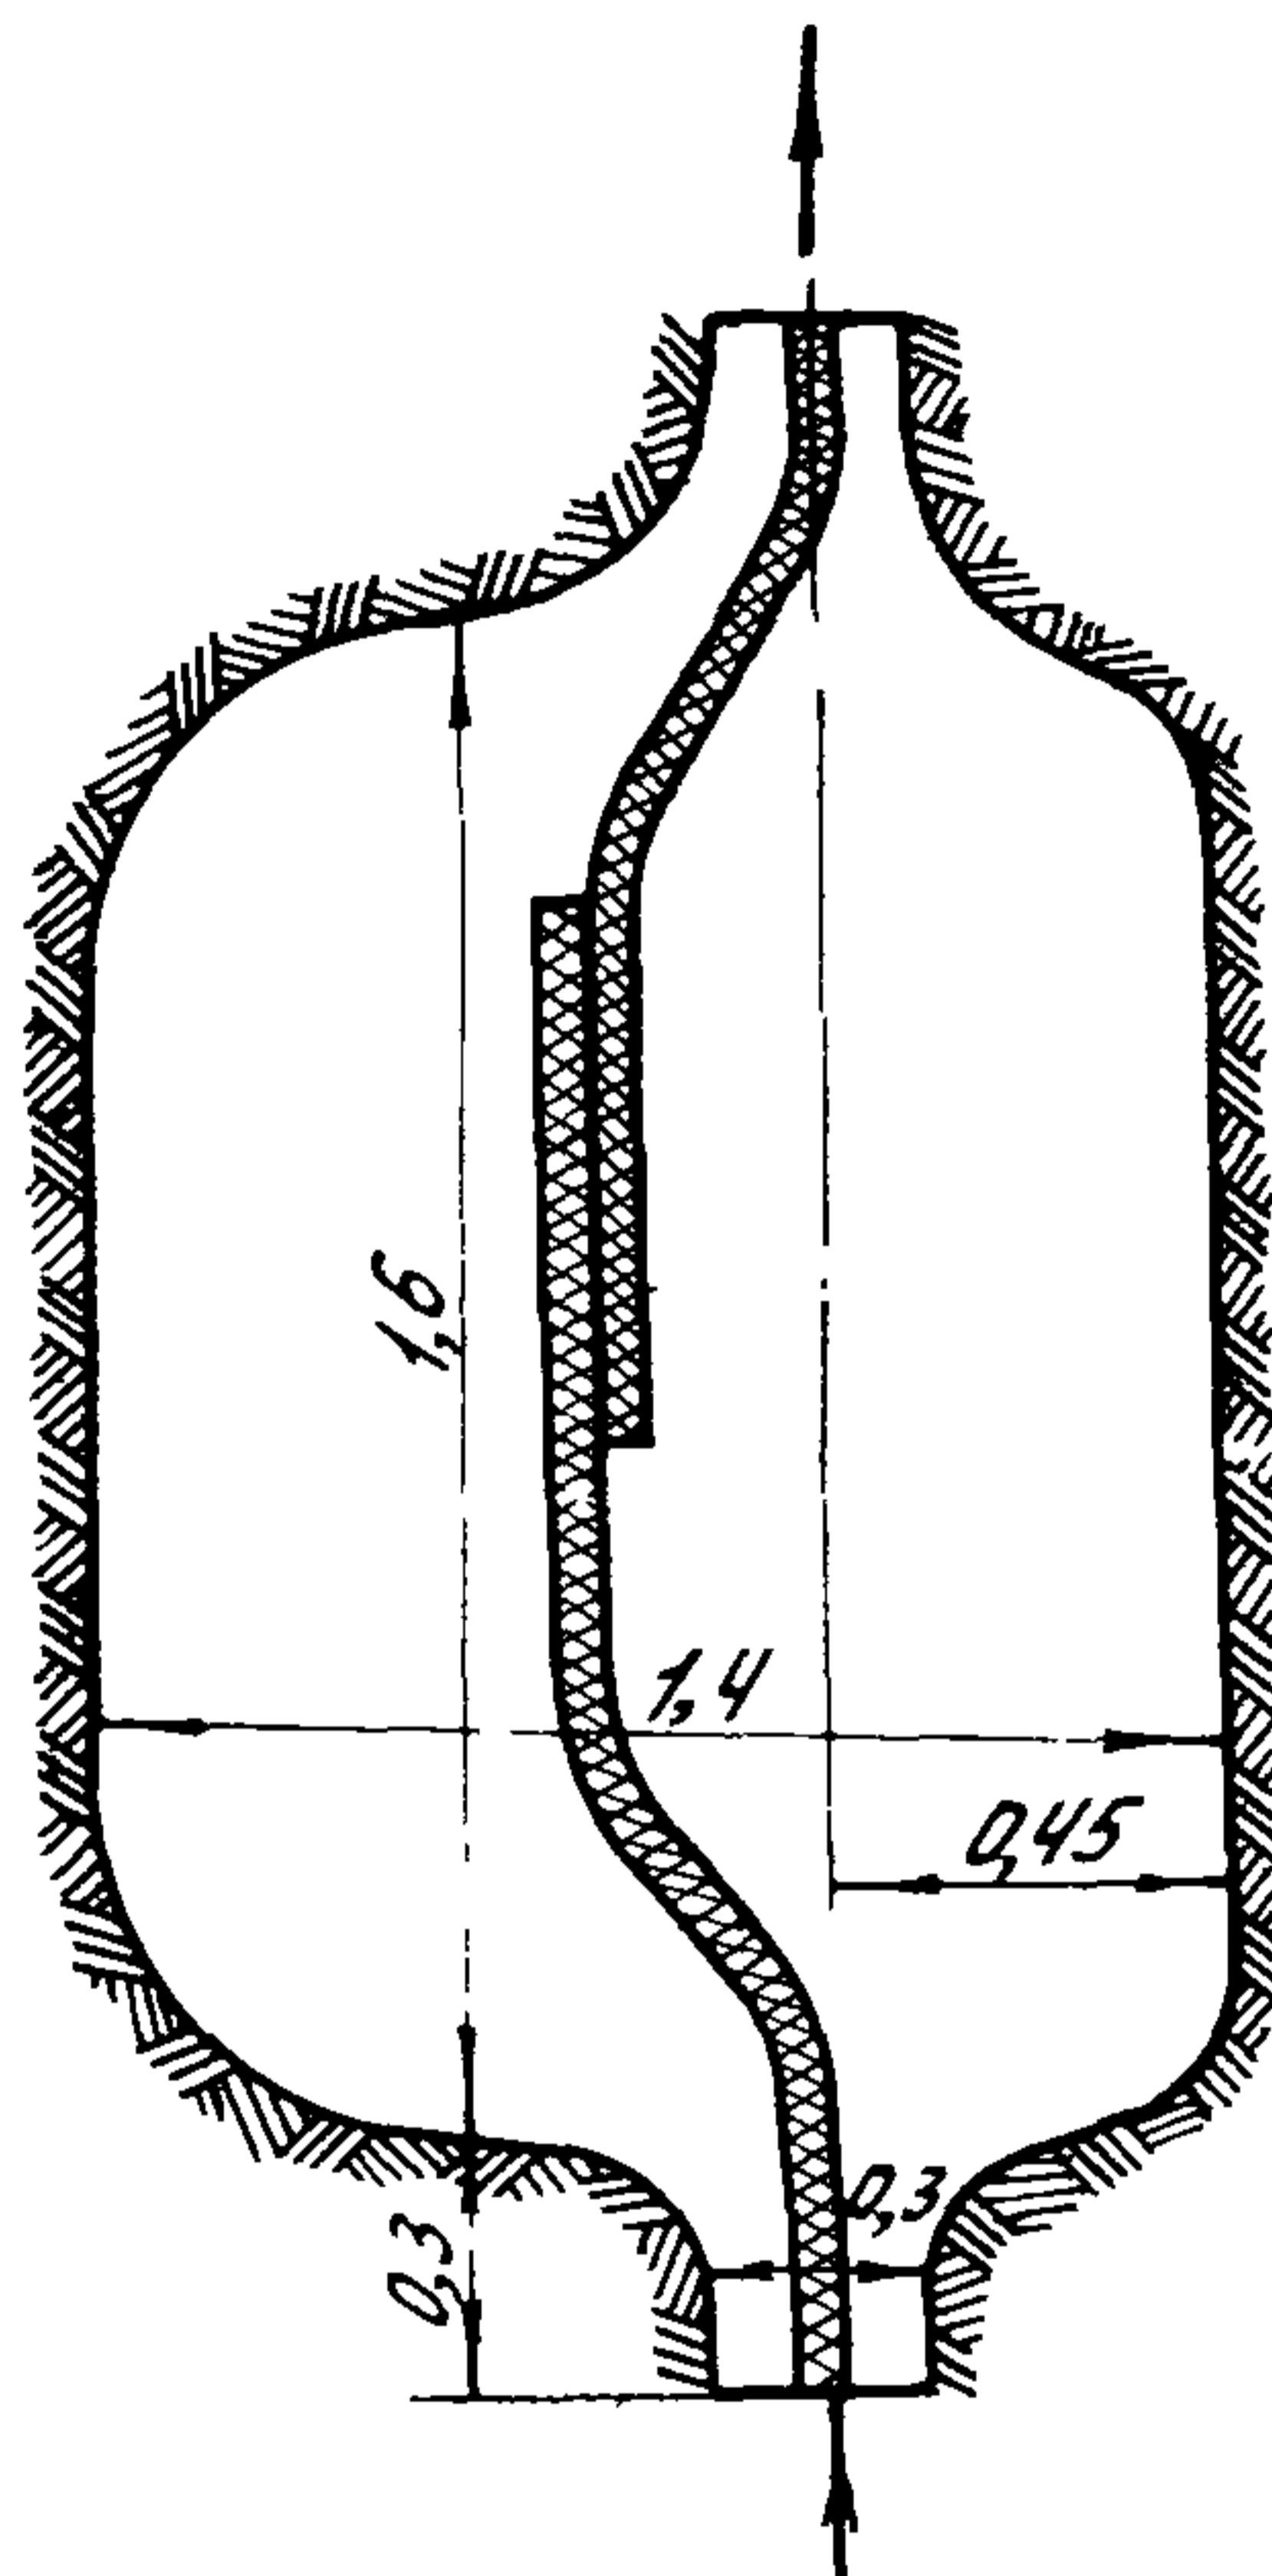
Котлован для монтажа муфт с выкладкой кабеля
